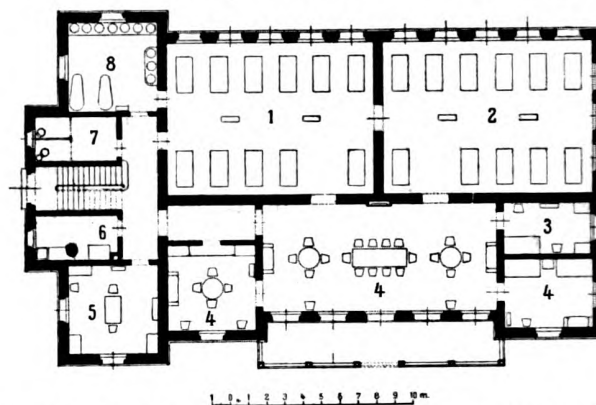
Grundriss des Ueberwachshauses für ruhige Kranke III. Classe. Nr. 20 des Planes.
